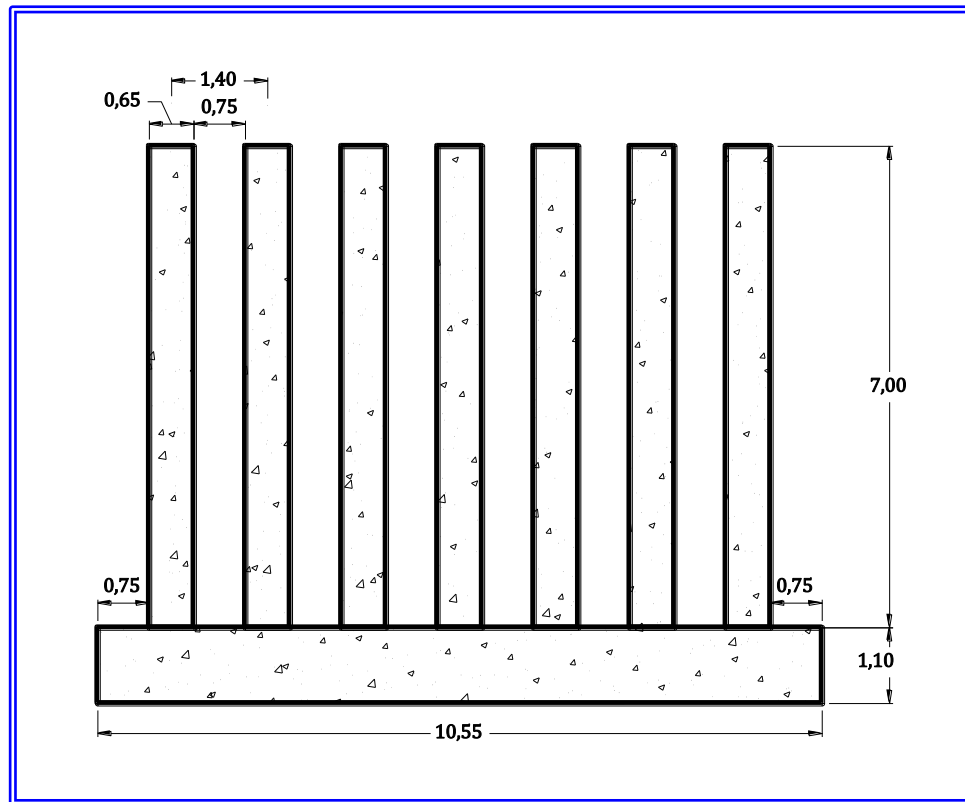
Vista frontal de presa con diente de 7 metros sin viga de amarre.
